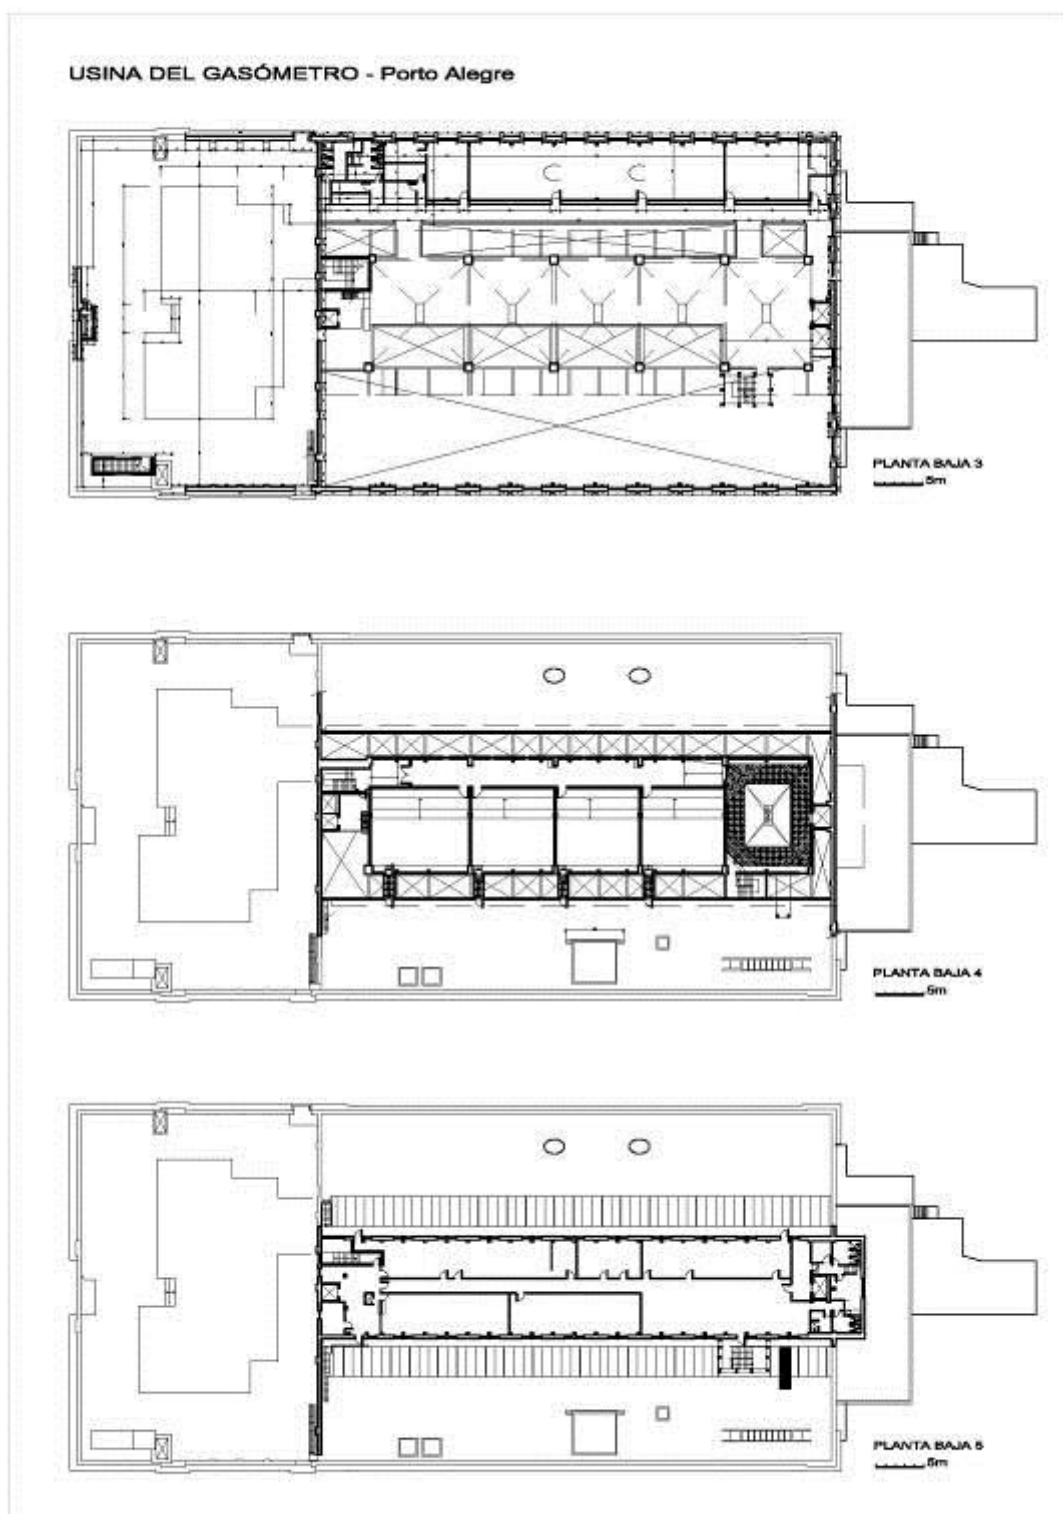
Usina del Gasómetro. Proyecto de restauración. Plantas Bajas, niveles 3, 4 y 5.
